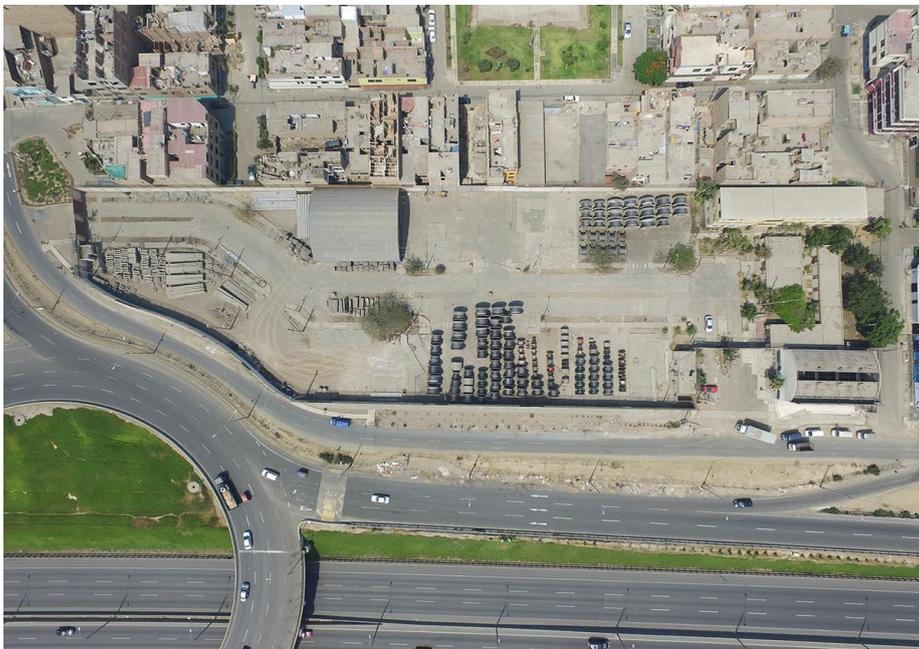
, Vista de planta del terreno con el óvalo infantas. Fuente propia.
